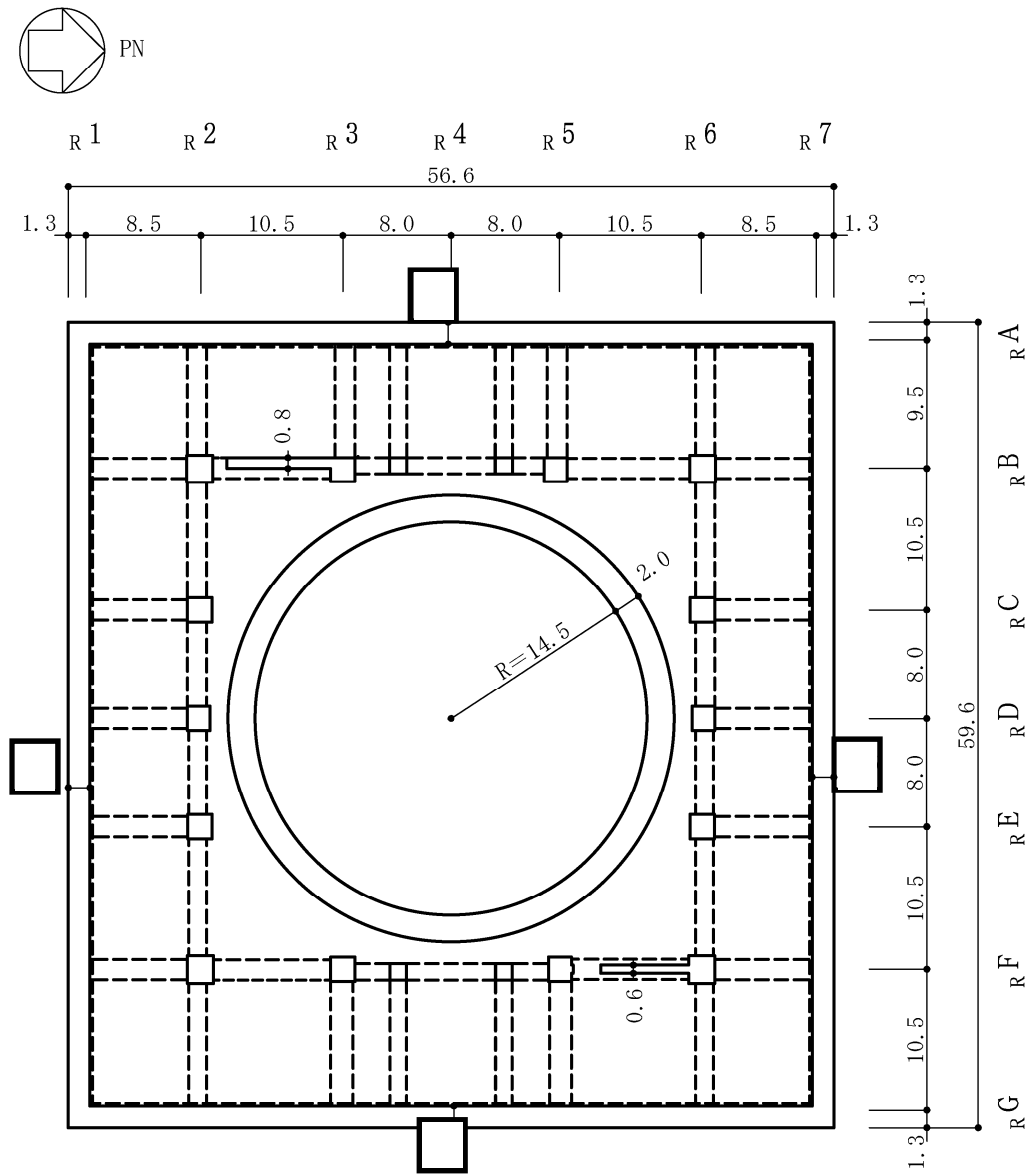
原子炉建屋の概略平面図 (B2F, T.M.S.L. -1.7m) (単位:m) (2/9)
